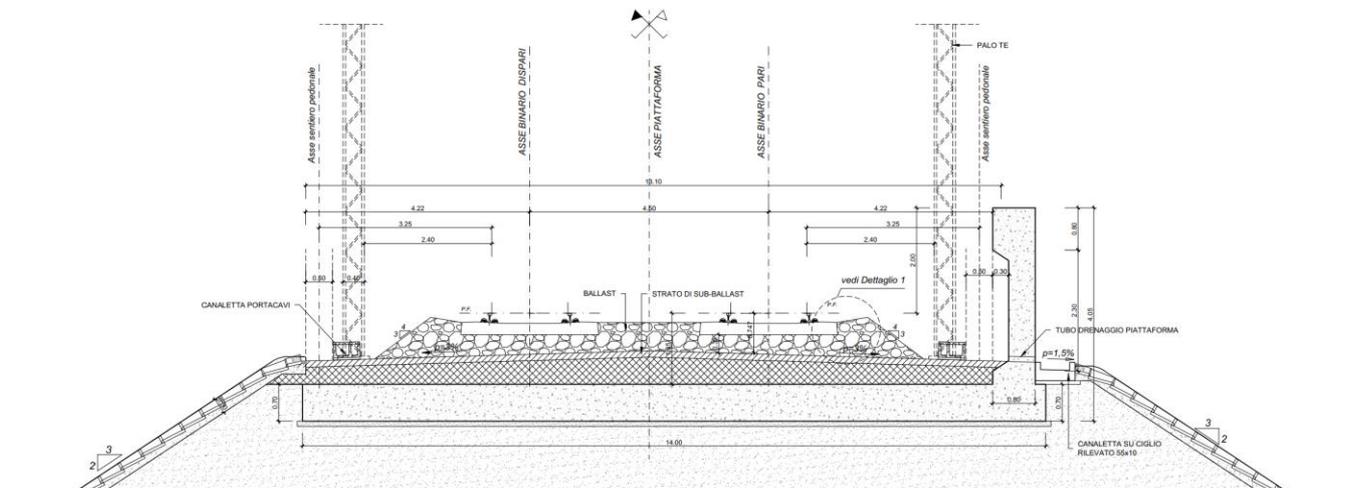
Sezione tipo in rilevato a doppio binario con muro di recinzione (tipo R01)
